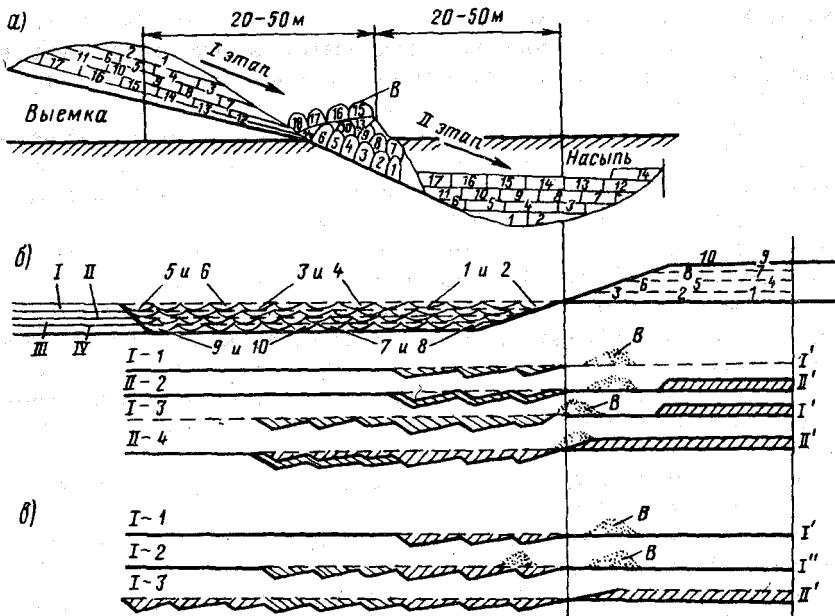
Схемы перемещения грунта бульдозерами в несколько этапов:
